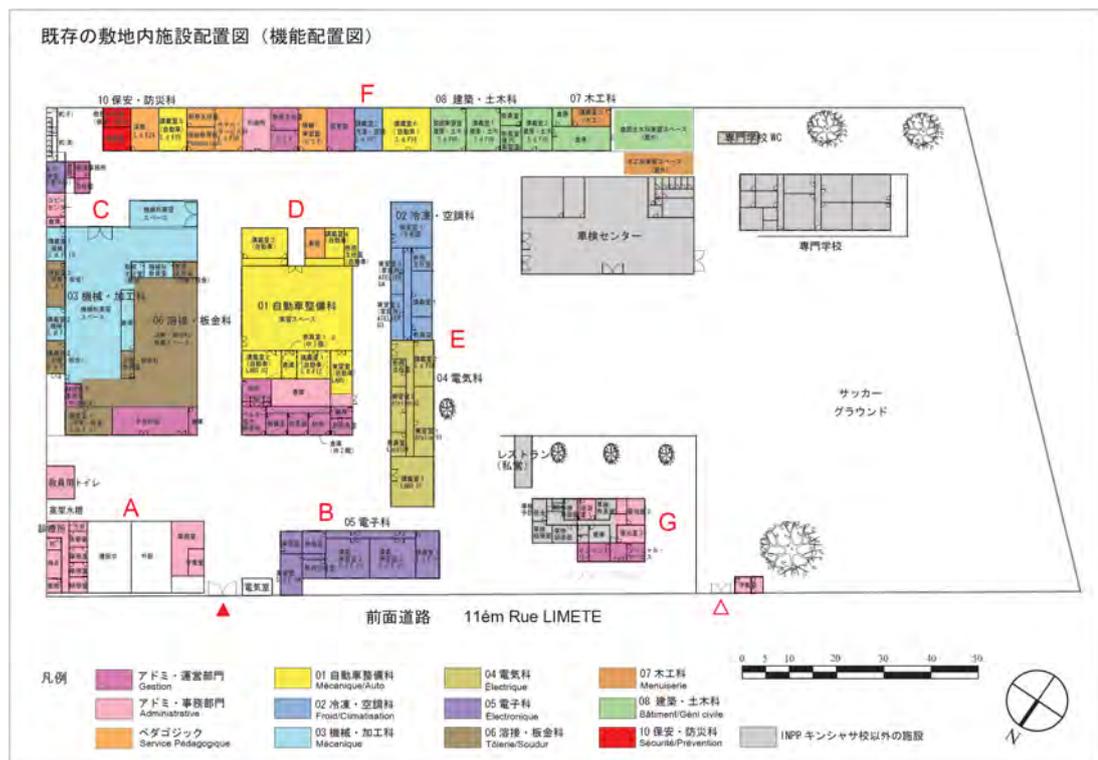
INPPK 敷地内施設配置図（機能配置図）
